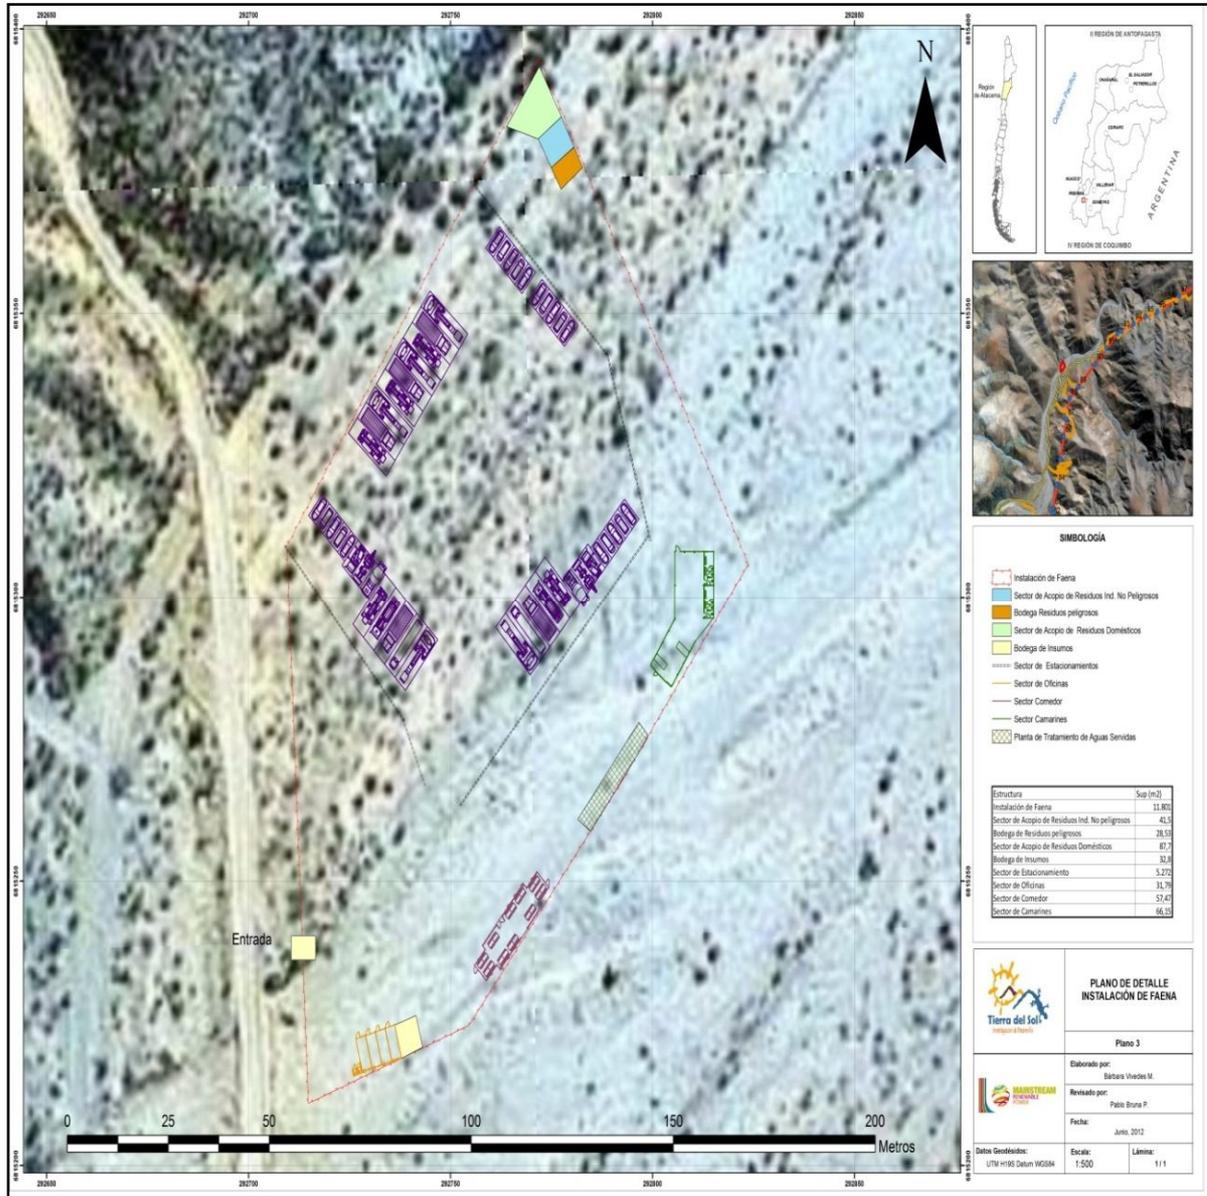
Plano de ubicación general de la Instalación de Faena (Plano N°3 del Anexo A).
